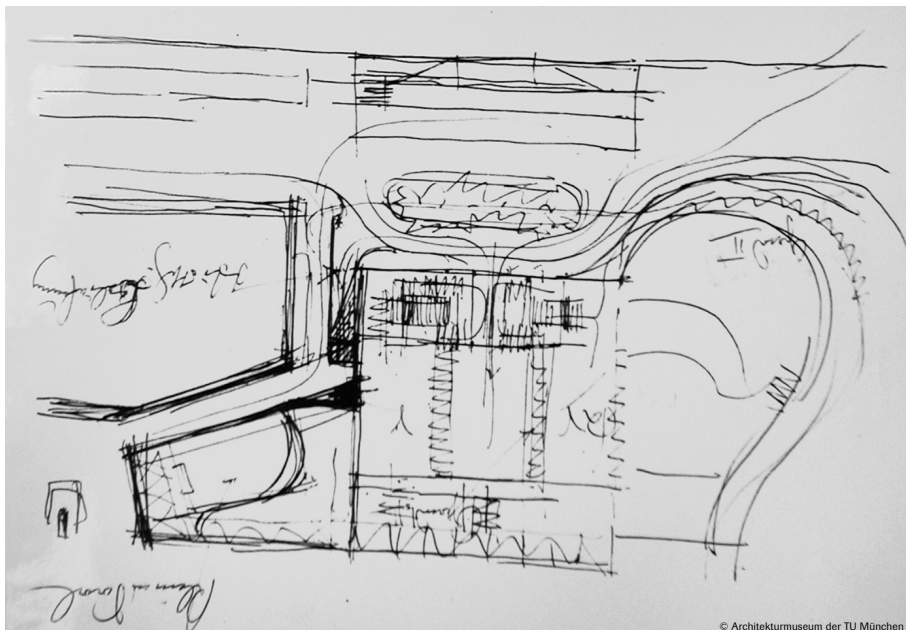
Die Baumassen wurden räumlich und funktional definiert. Grundrisssskizze: Adolf Abel, 1953.
